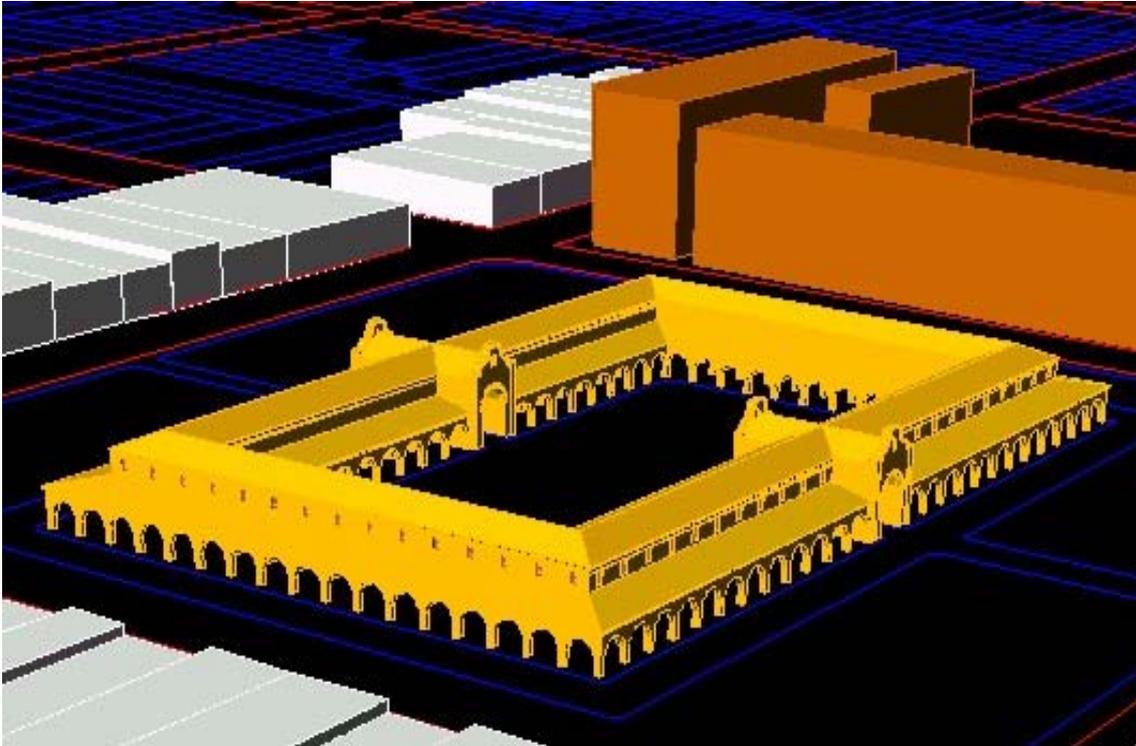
Maqueta tridimensional de la estructura original del mercado.
